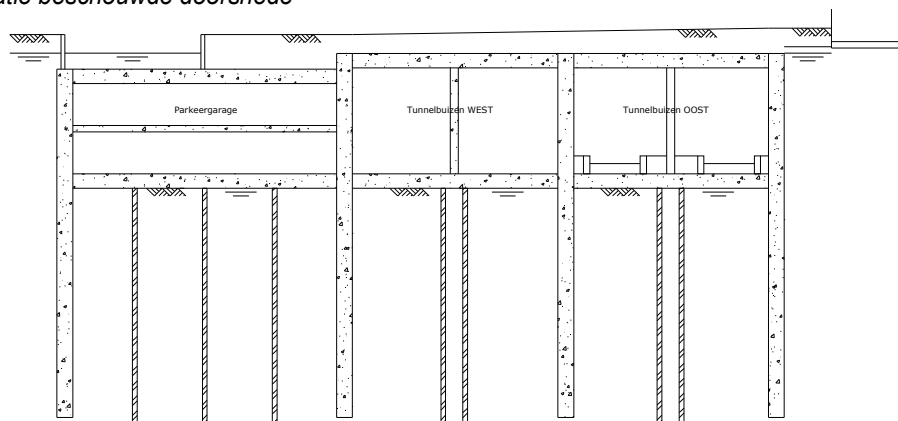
Geometrie parkeergarage en tunnelbuizen tpv. Phoenixstraat 30
